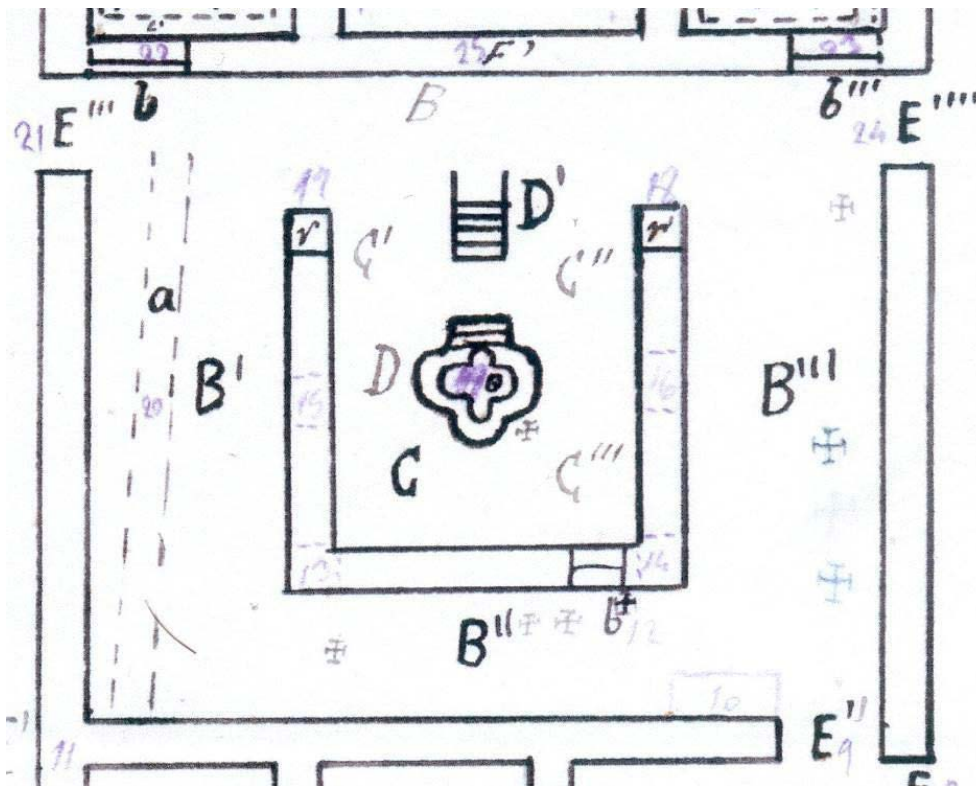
Detalle de la zona del Sector Baptisterio de la planta original de J. Aguiló (Museu d'Història de Manacor)
